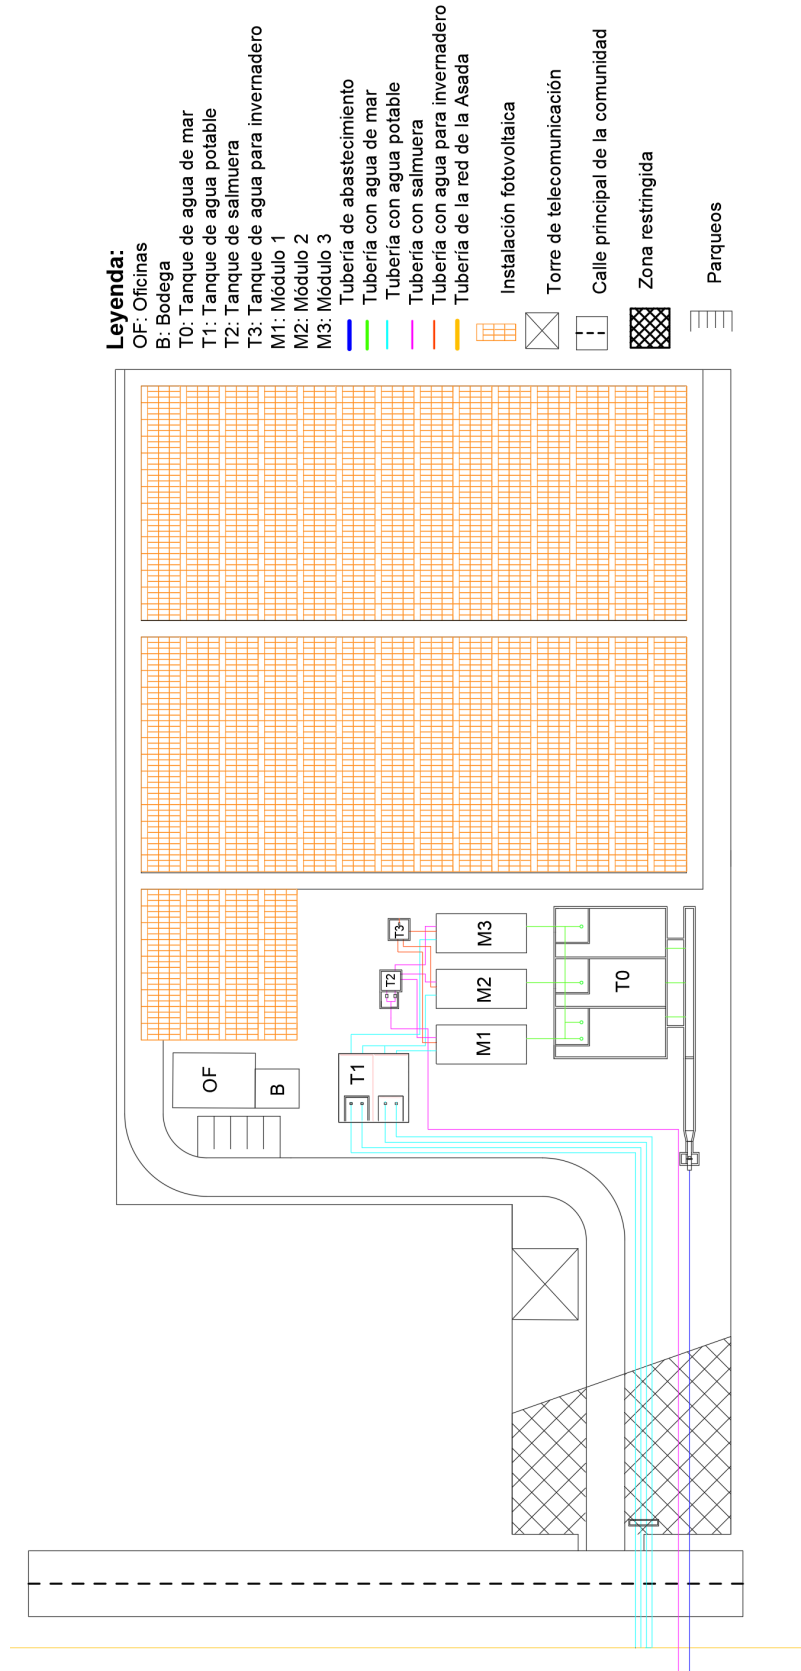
Distribución de planta final del proyecto (Elaboración propia, 2018)
